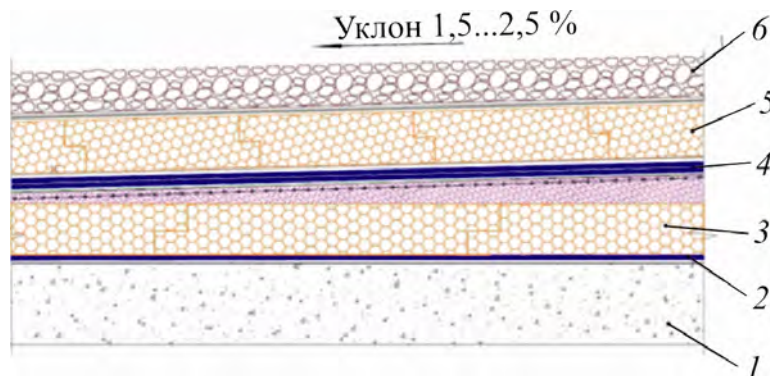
Утепление плоских крыш: 1 — плита покрытия; 2 — пароизоляция; 3 — утеплитель; 4 — восстановленный гидроизоляционный ковер; 5 — утеплитель; 6 — пригрузочный слой гравия
